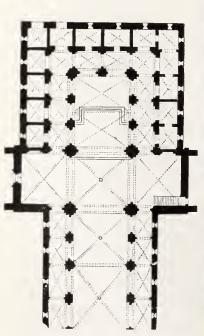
Kirche zu Riddagshausen. Grundriß.
